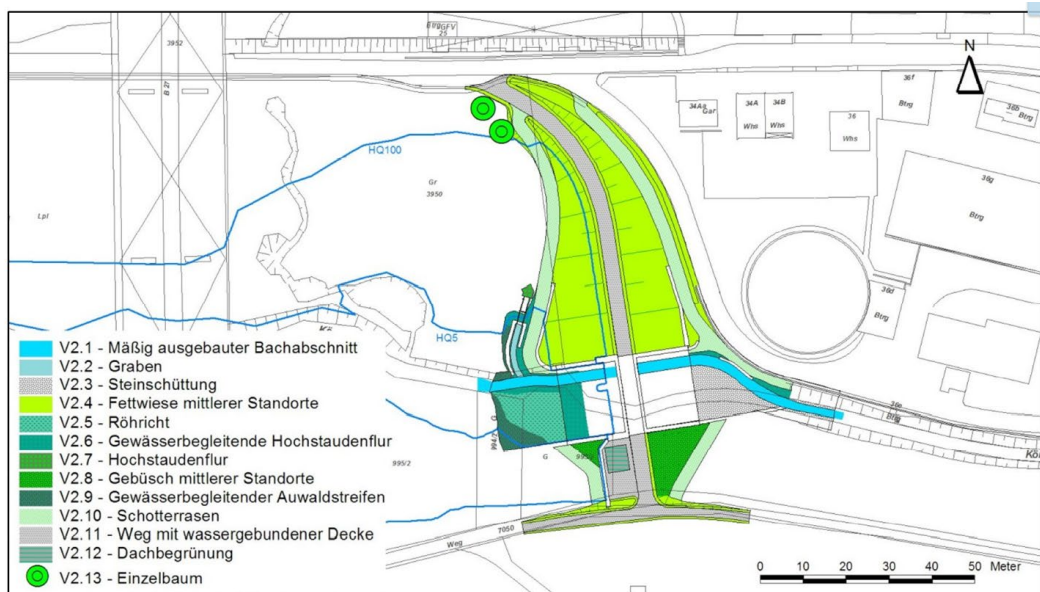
Minderungsmaßnahmen im Bereich des geplanten Dammbauwerks aus dem Landschaftspflegerischen Begleitplan (Stand 13.12.2019; Abbildung übermittelt durch GefaÖ, Stuttgart).
